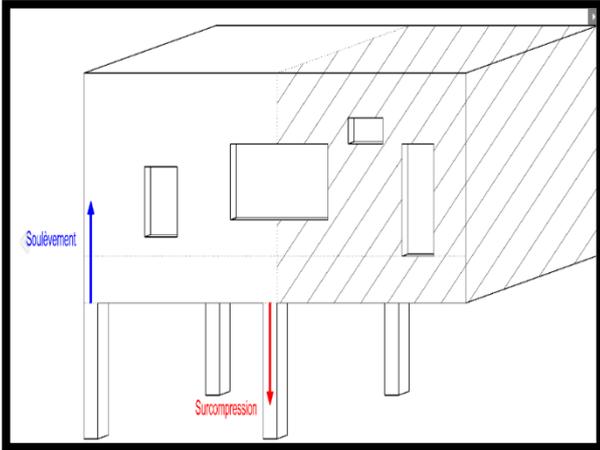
Principe de transmission des forces de la porte a faux vers les fondations
